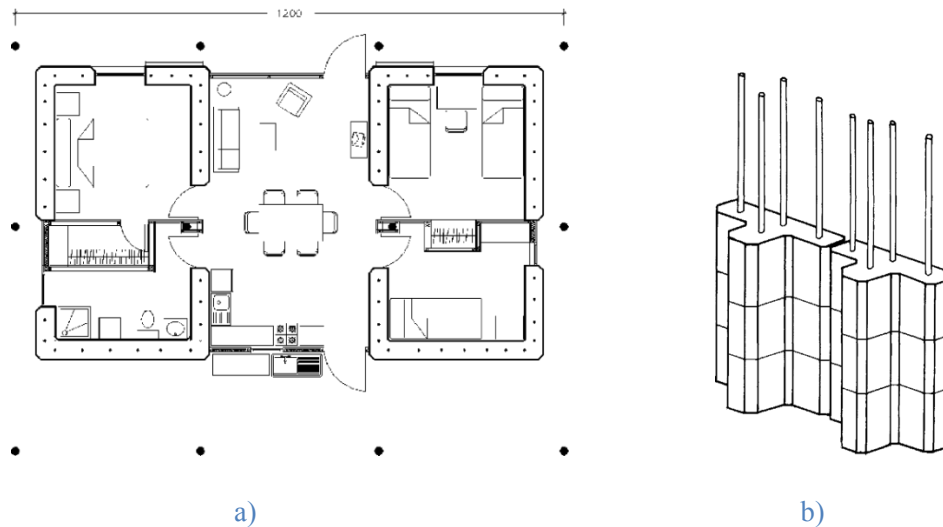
Diseño de vivienda antisísmica; a) planta arquitectónica y b) detalle de refuerzo de bambú (Minke, 2001).
